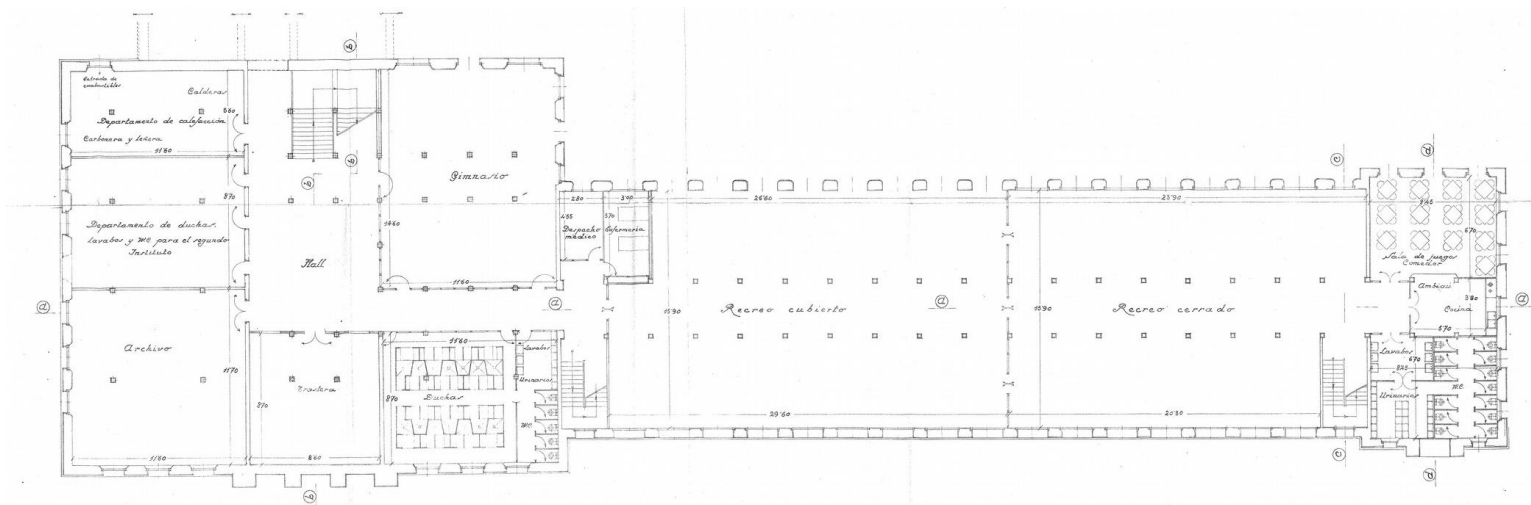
Plano de la planta semisótano, Manuel Sureda 1942
